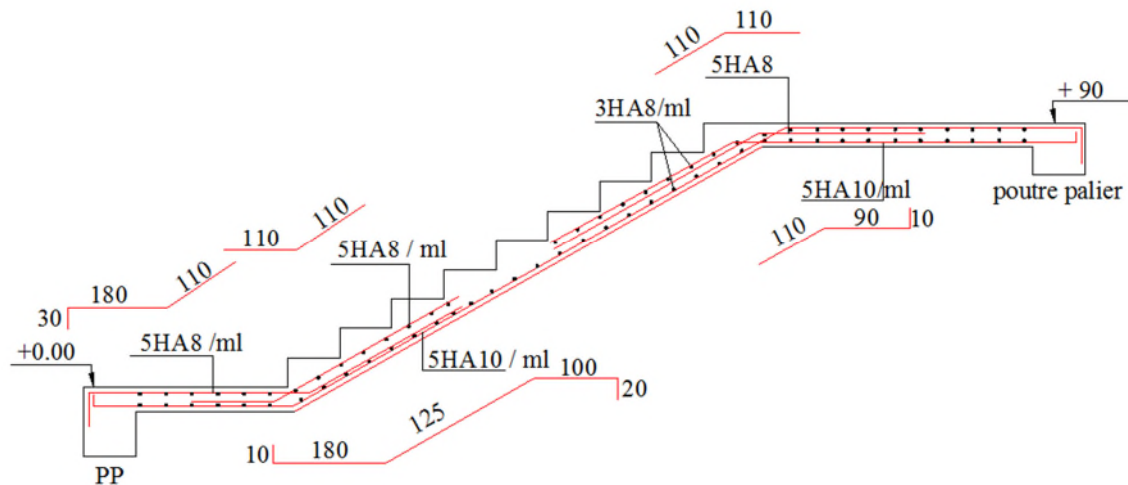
Schéma de ferrailage de l'escalier droit à une volée
